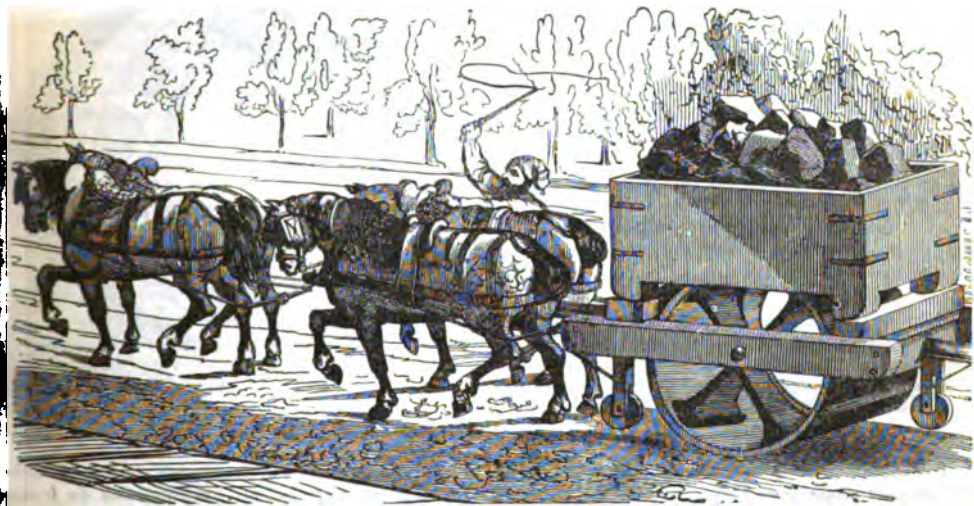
Rouleau compresseur pour chaussées d'empierrement.
